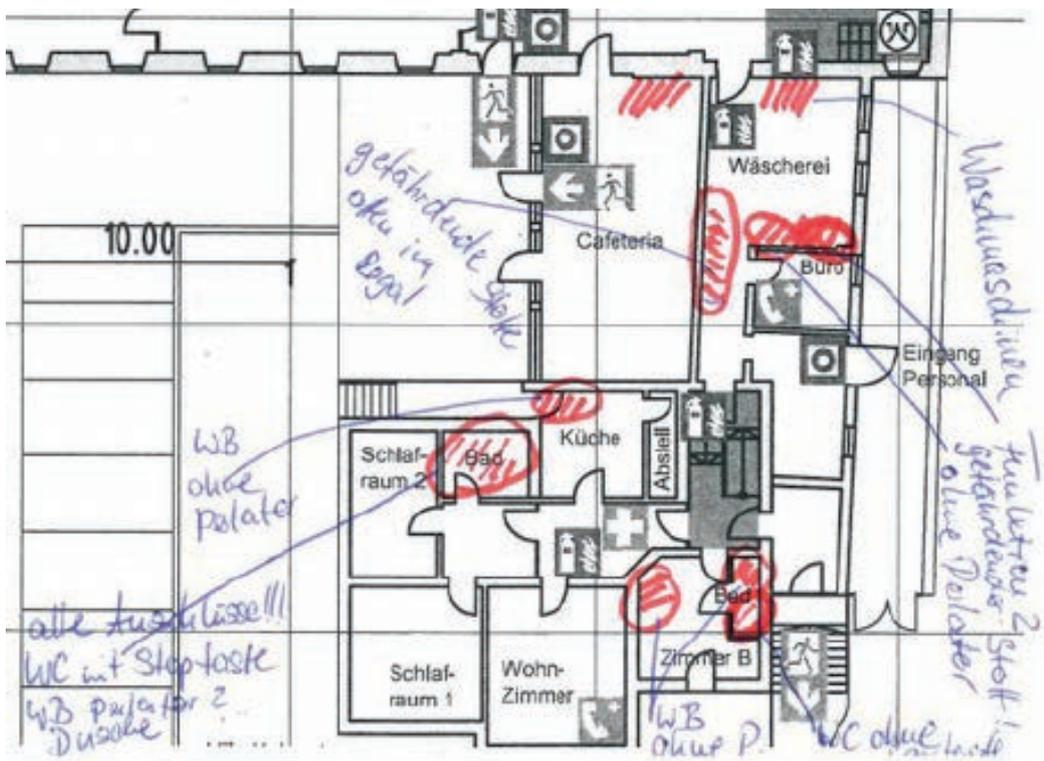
Grundrissausschnitt aus dem Ecomapping®. Die Abbildung zeigt einen Ausschnitt aus dem Erdgeschoss des Jugendhauses, bearbeitet von der Kleingruppe „Wasser/ Abwasser“.
